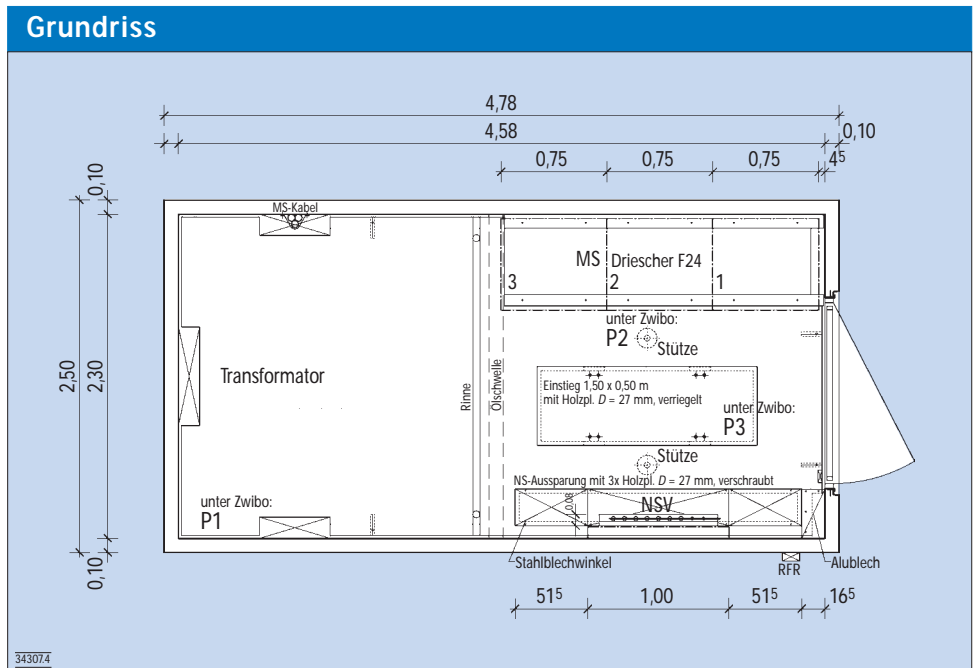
Grundriss der geprüften Station K 2000; P1, P2, P3 = Druckmessorte
